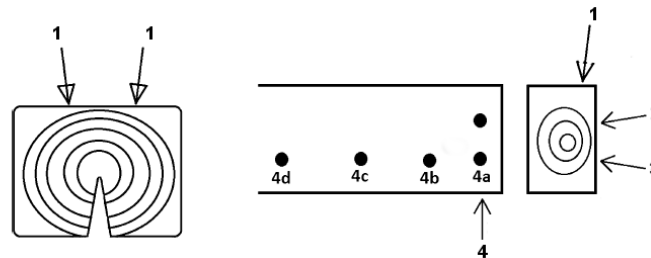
Princípios orientadores escolha da localização dos furos no caso de uma viga de pavimento, adaptado de [11]
